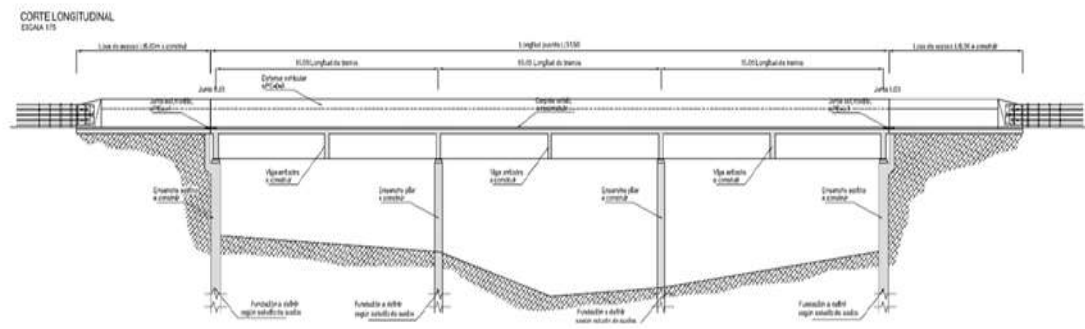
Ensanche de puente sobre Arroyo El Gato o Navarrete PR 6+320
